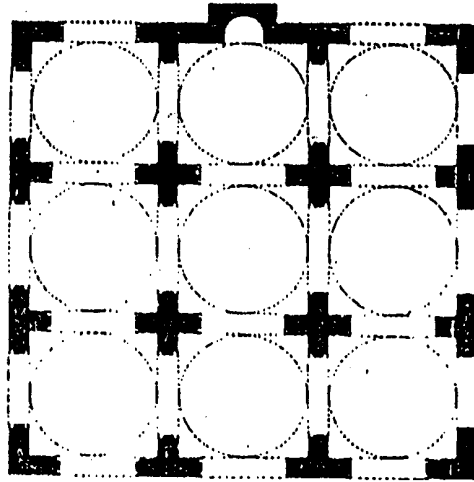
مسقط أفقي لجامع مراد أغا في تاجوراء بليبيا (عن : EL - Mahmudi)
